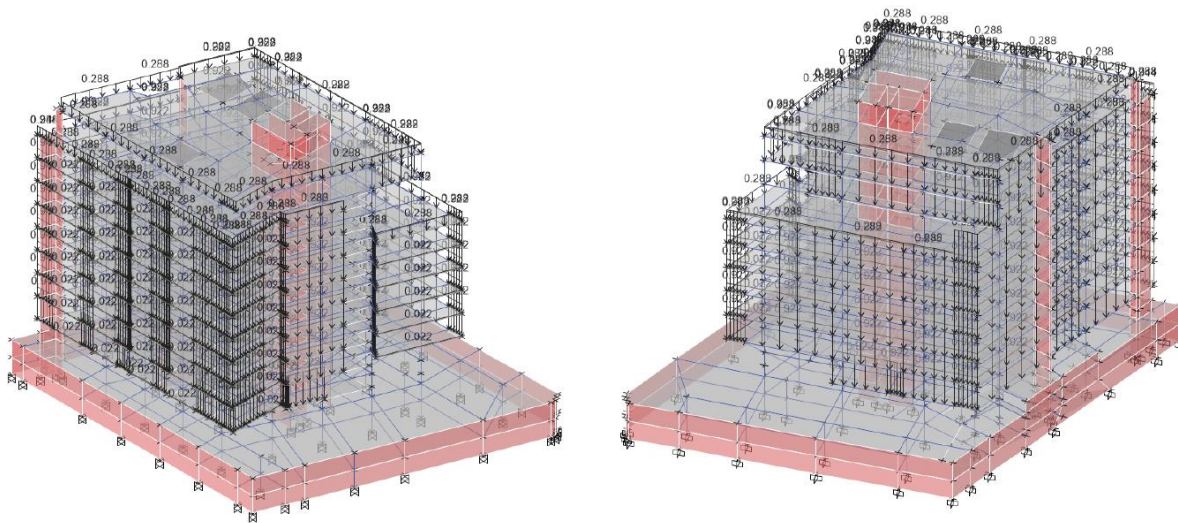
Asignación de cargas de mampostería y muros cortina en fachadas
